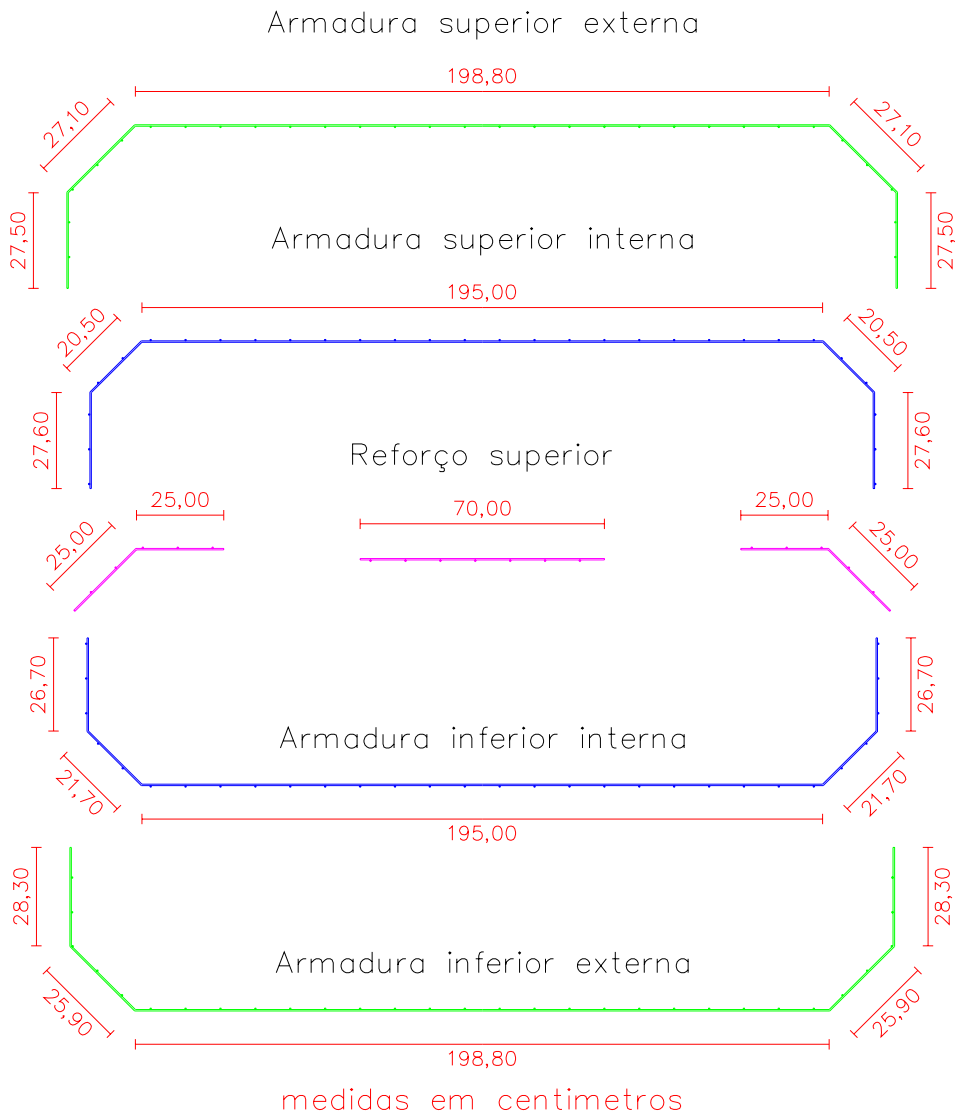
Detalhamento da armadura em tela soldada.
